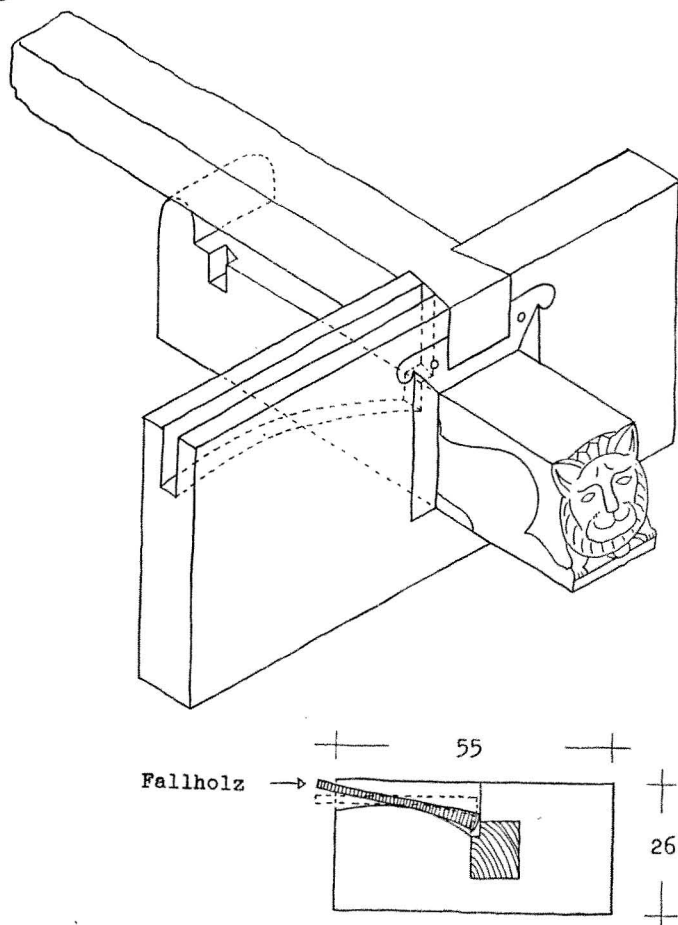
Löwenriegel aus Holz. Darunter schematische Darstellung der Fallholz-Konstruktion.
